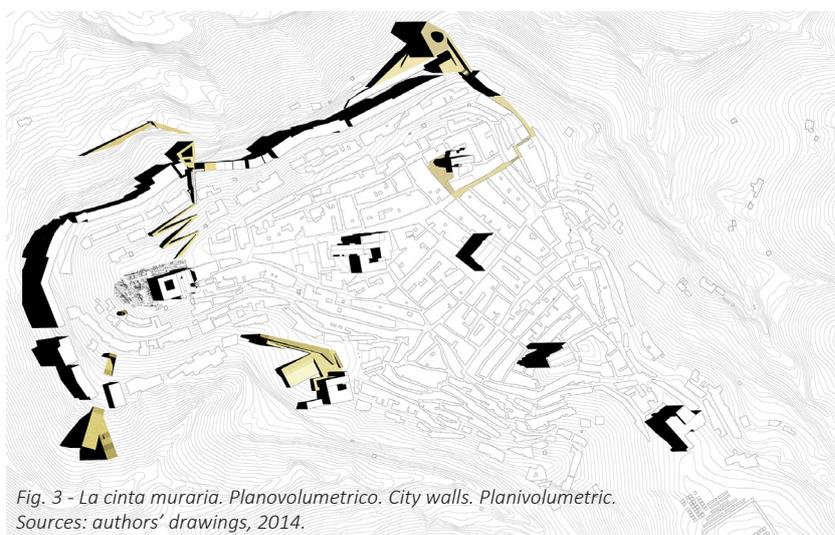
La cinta muraria. Planovolumetrico. City walls. Planivolumetric. Sources: authors' drawings, 2014.
